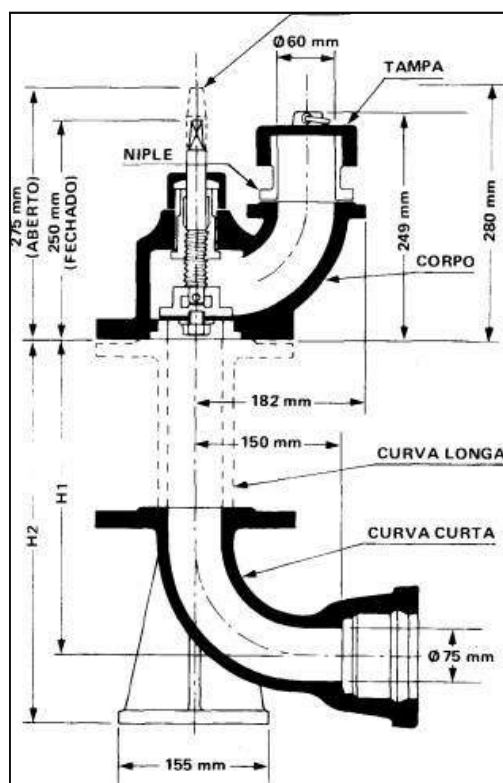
Esquema em corte para instalação de um hidrante subterrâneo
